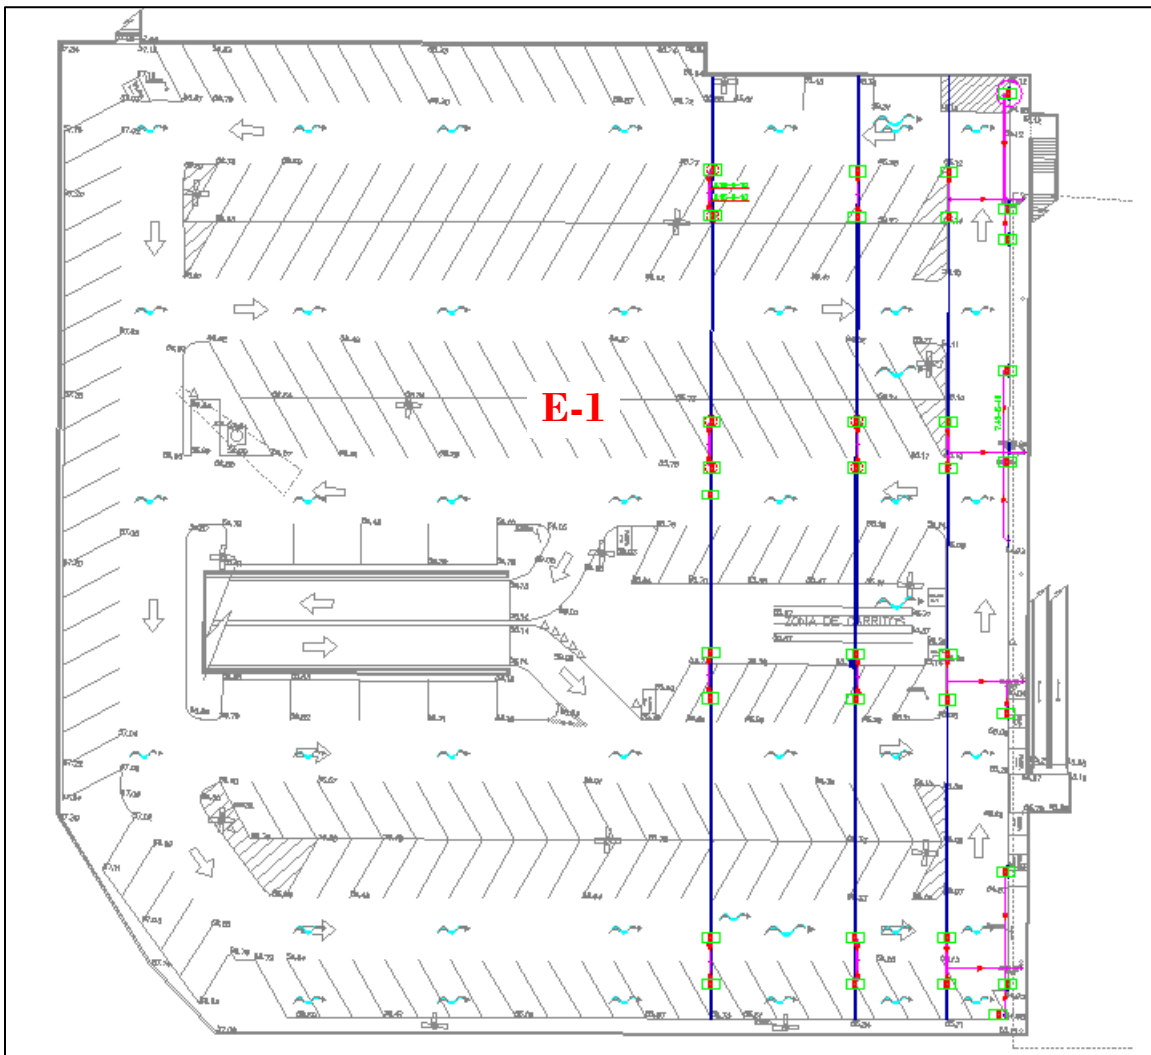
Estacionamiento planta alta (vista en planta).
